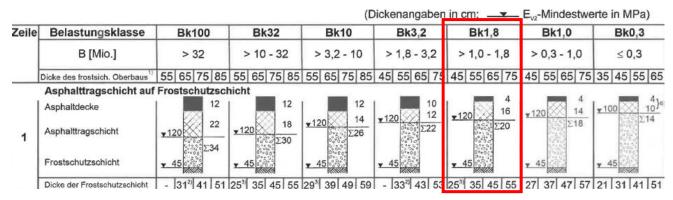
Bauweisen mit Asphaltdecke nach RStO 12/24 Tafel 1
